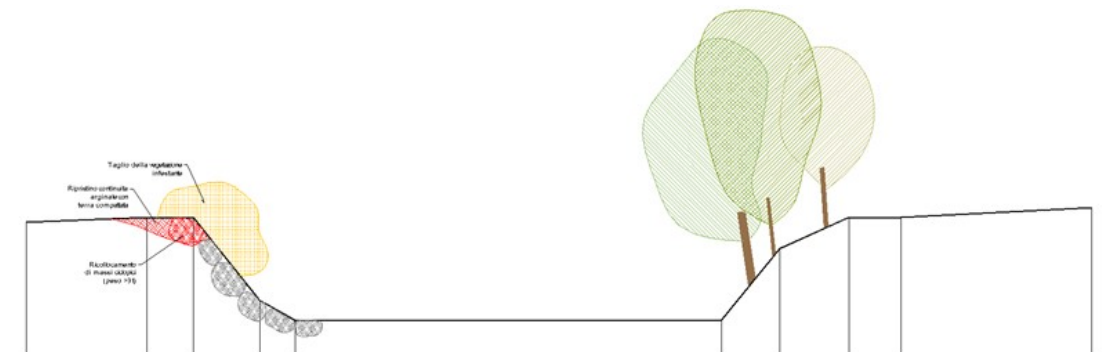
Sezione con schema di intervento da attuare presso l'argine sinistro a valle del pontecanale Villoresi
